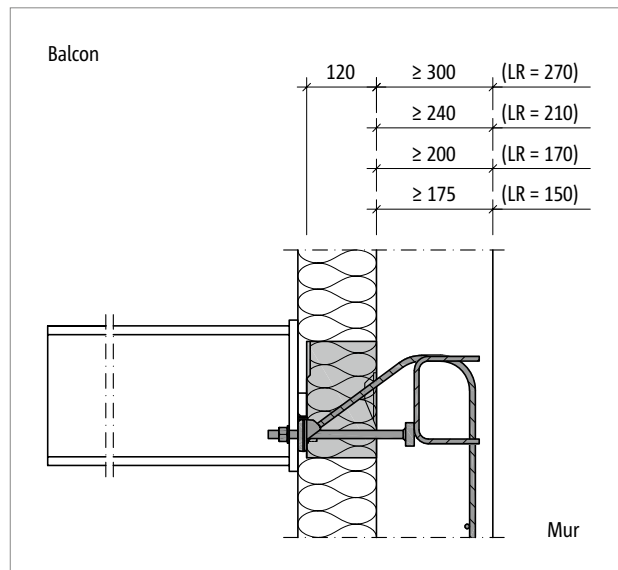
Schöck Isokorb® XT type SQ-WU : construction spéciale pour raccord mural
